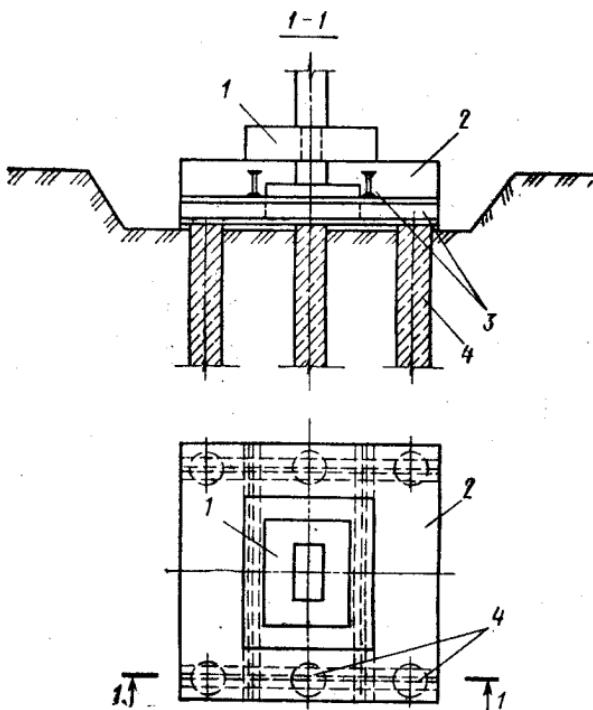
Усиление столбчатого фундамента на естественном основании с устройством ростверка, армированного металлическими балками:
